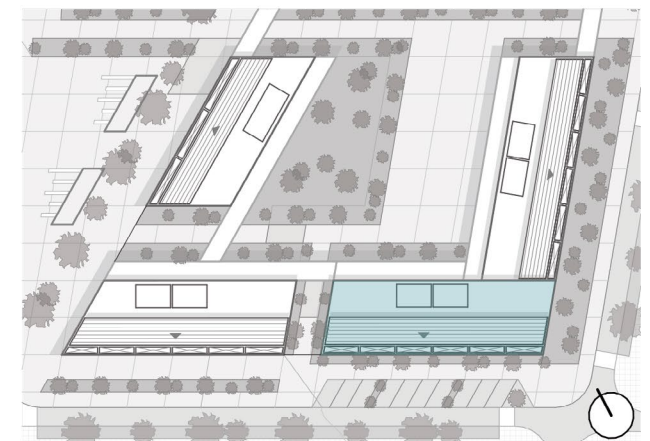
| Planta Alta | Fuente: Autoría propia. (2023).
